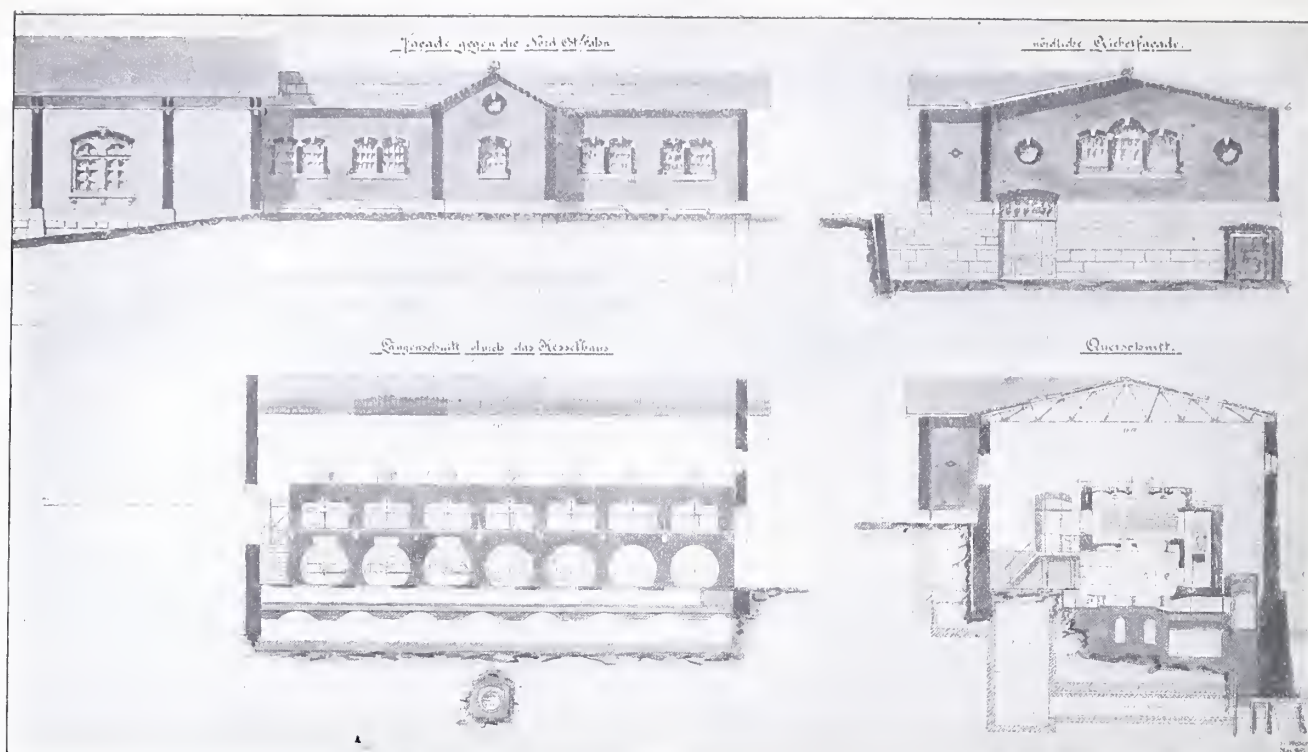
Kesselhaus. — Fassaden und Schnitte 1:400.
